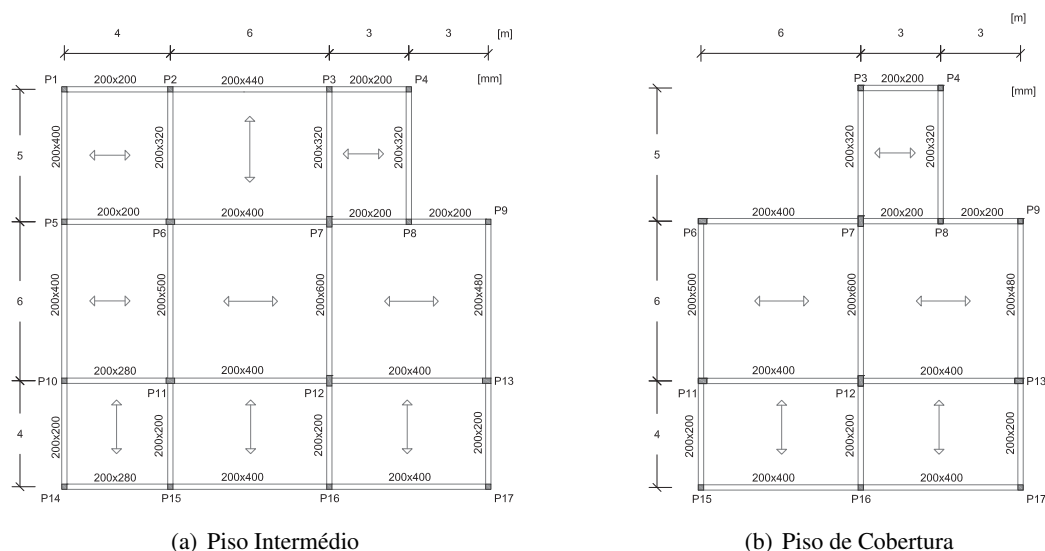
Planta estrutural referente à Solução Estrutural 1
